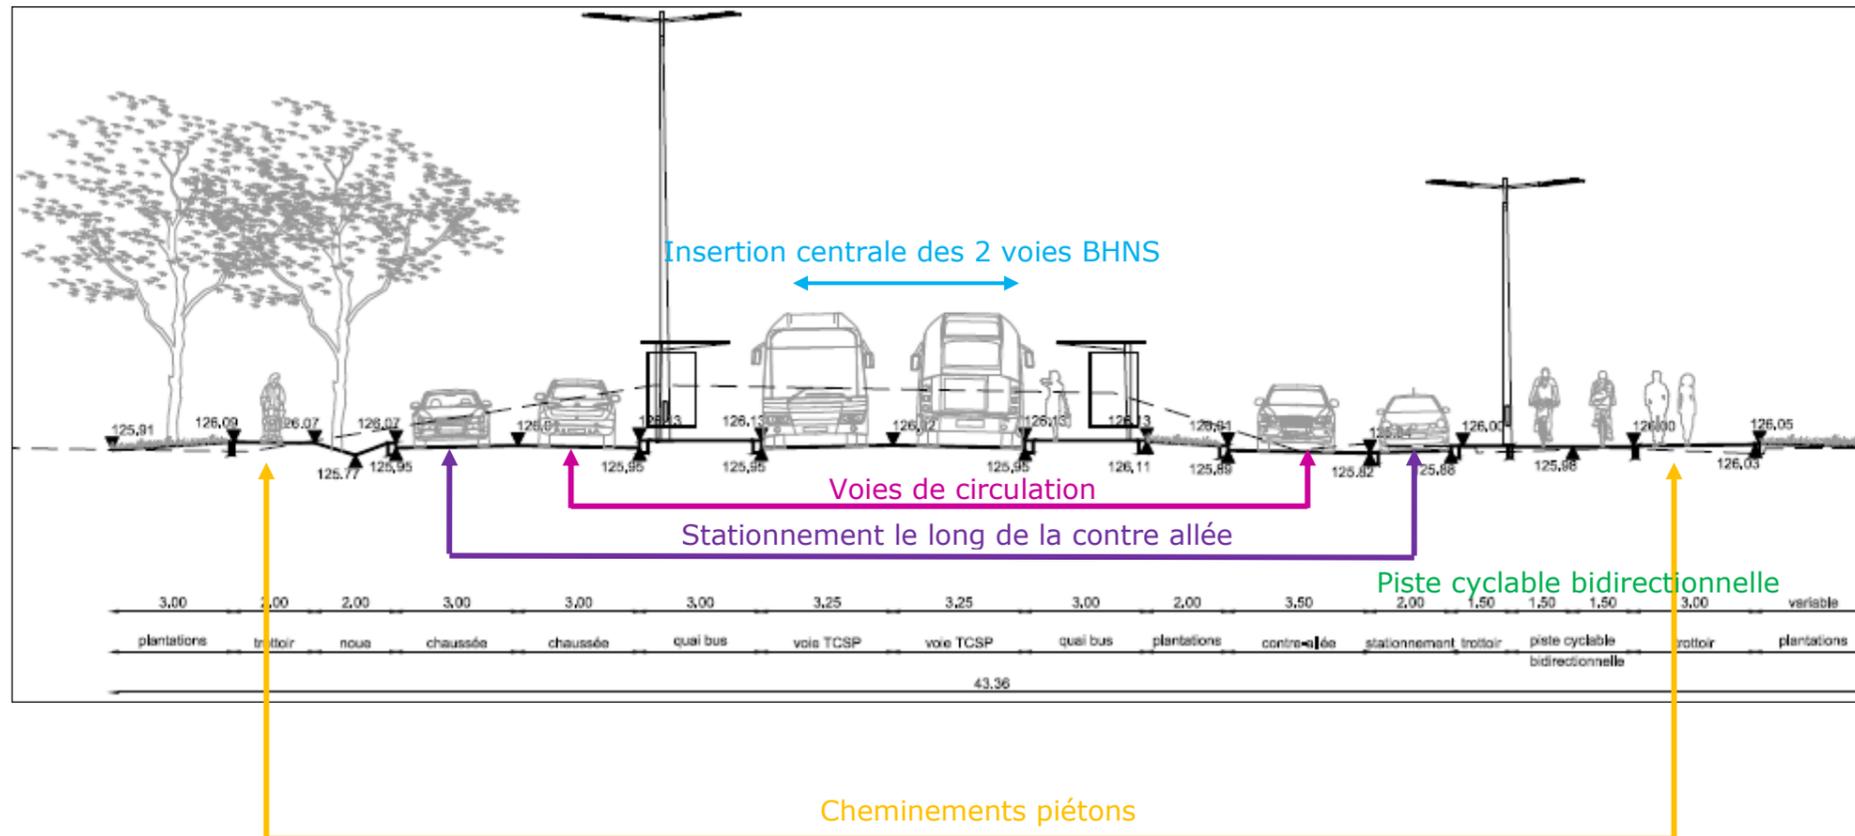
Profil en travers type dans le cas d'une contre-allée avec stationnement – Exemple sur l'avenue Normandie Niémen (Source : Etudes AVP)
